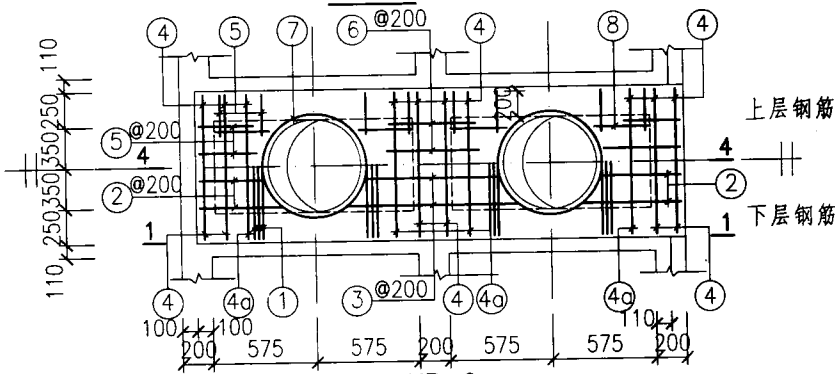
~7号钢筋混凝土化粪池现浇盖板配筋图(一)	图集号	11BS4
